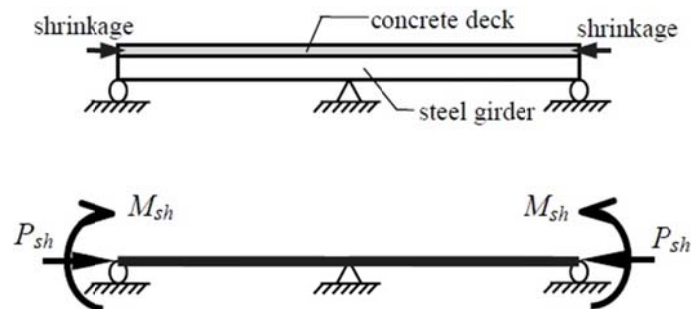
Esforços por retração em seção mista. Trad: *Concrete Deck* (Laje de Concreto), *Steel Girder* (Viga de Aço), *Shrinkage* (Retração) (WU; BOWMAN, 2000)
